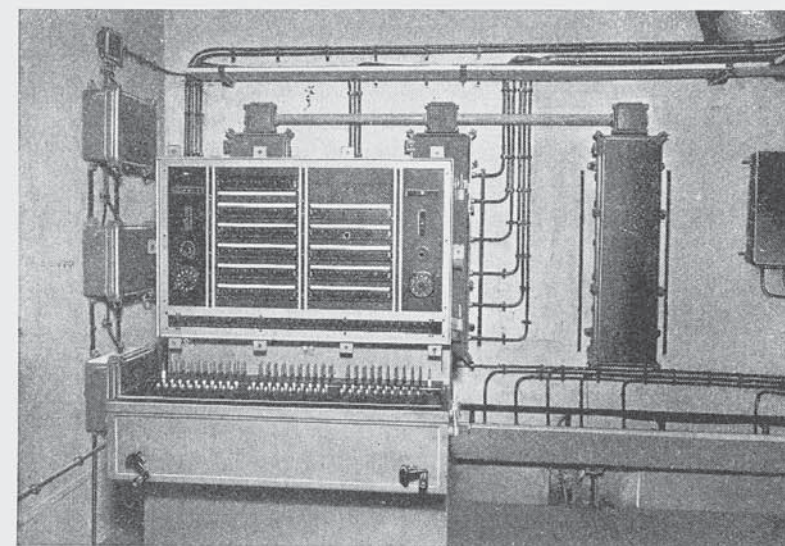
Festungsvermittlung zu 100 Leitungen, betriebsfertig eingebaut
